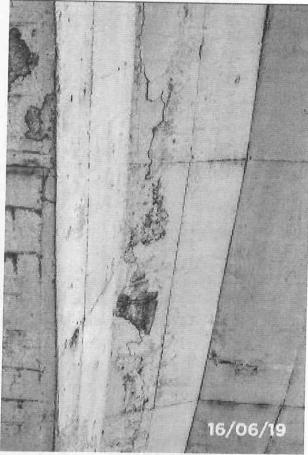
Detalhe de desplacamento do concreto e processo de infiltração.
